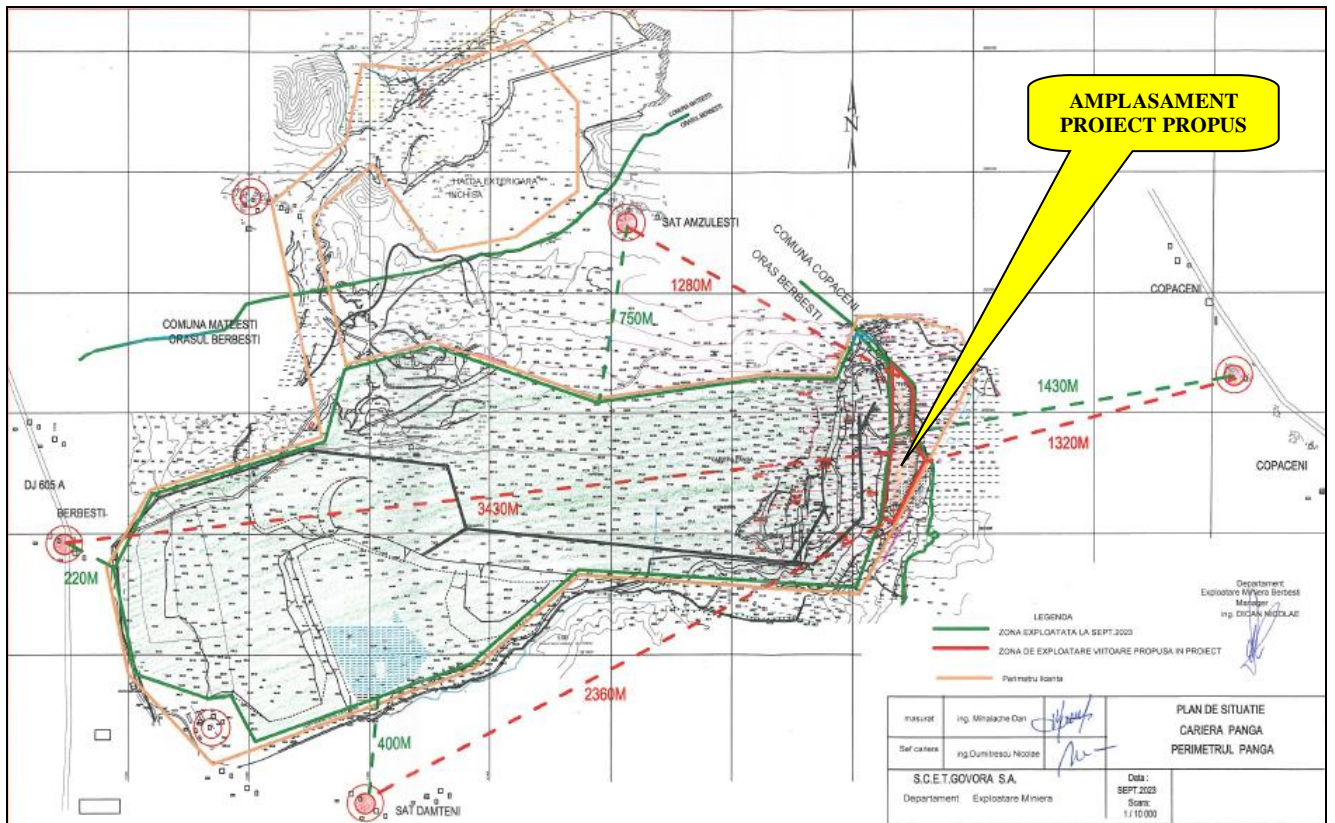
Plan de situatie – scara 1 : 10.000
